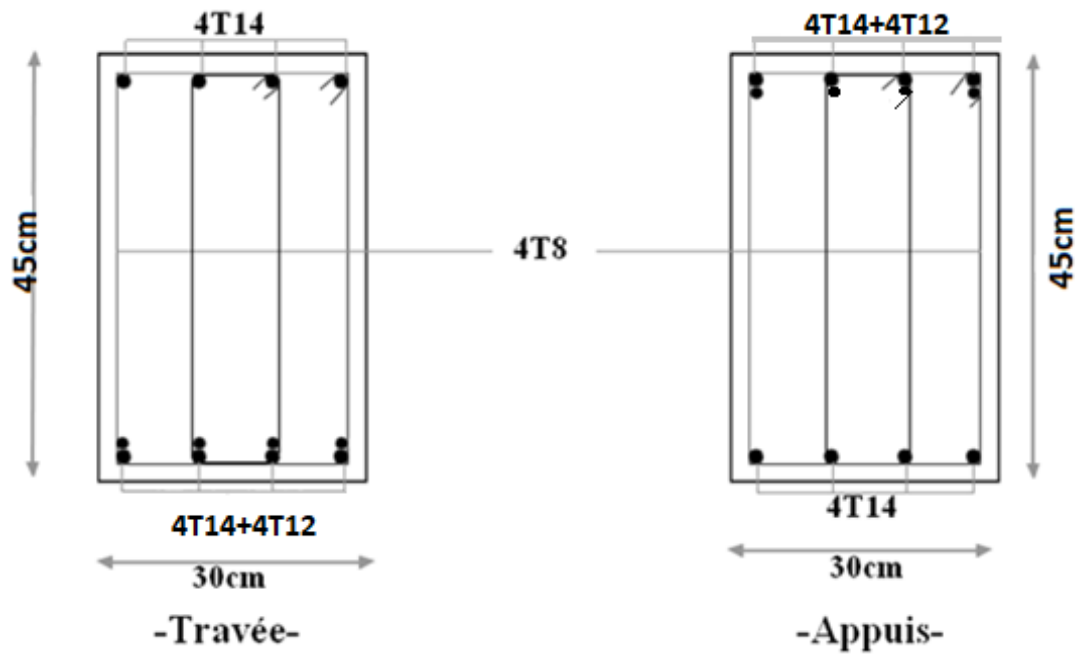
Schéma de ferraillage des poutres principales d'étage courant.
